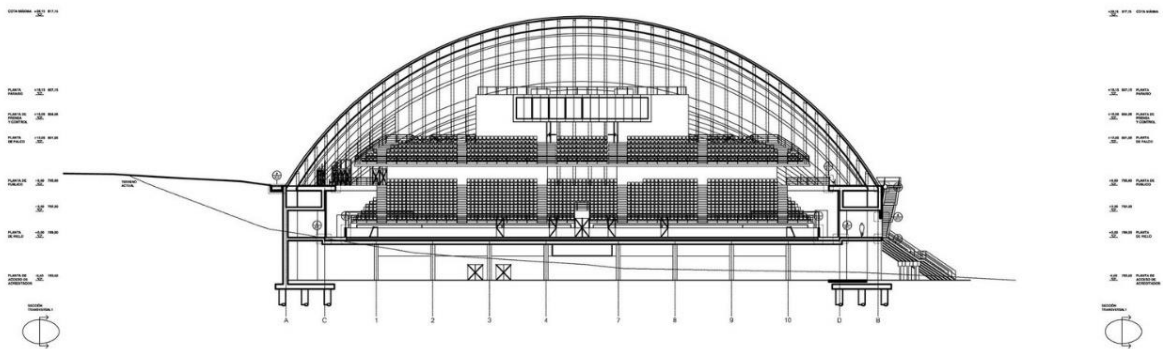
Поперечний розріз, арх. Coll-Barreu Arquitectos: Coll-Barreu Arquitectos – Juan Coll-Barreu & Daniel Gutiérrez Zarza [4]
